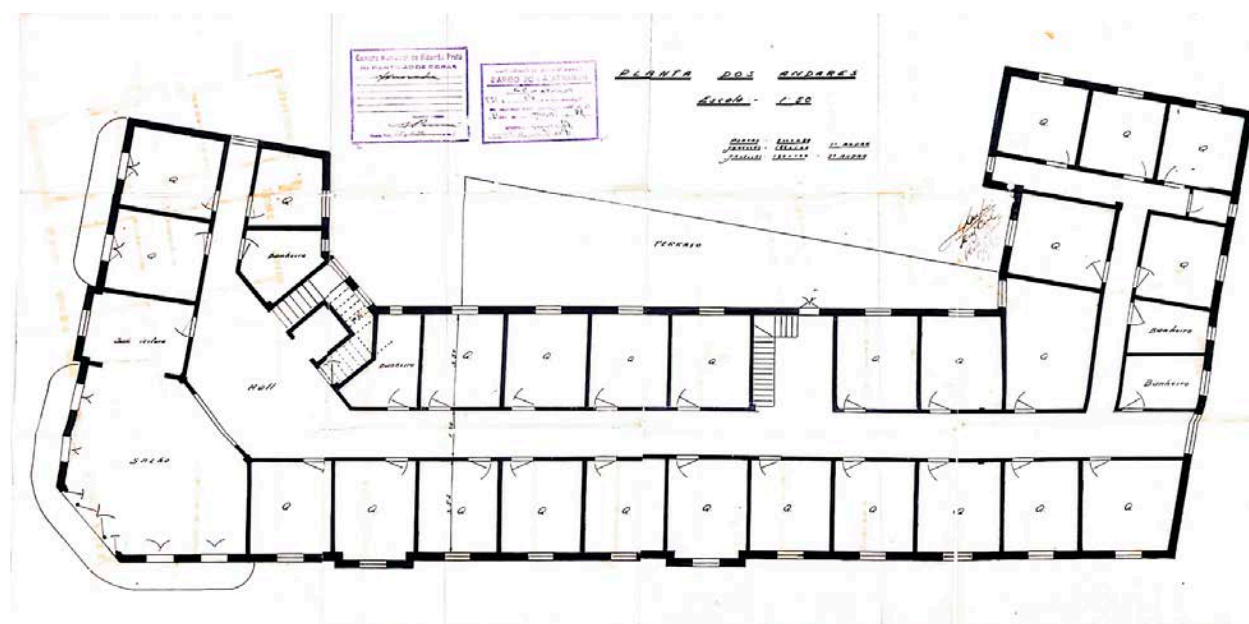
Planta baixa do pavimento-tipo. Fonte: APHRP.
